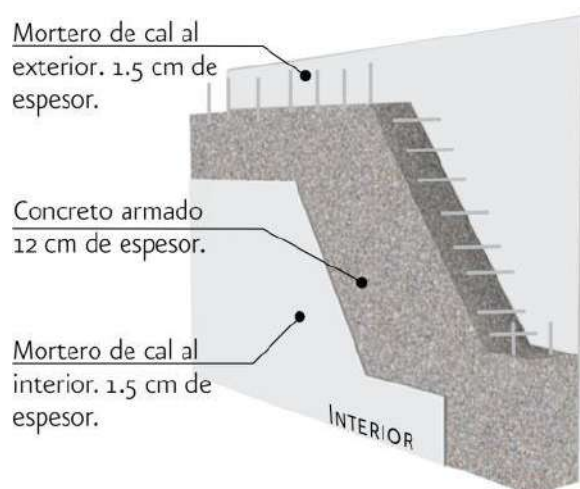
Ejemplo de detalle constructivo de muro de concreto armado.
